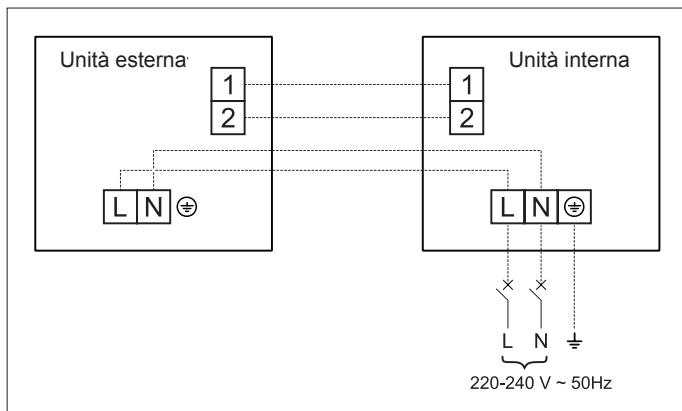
Collegamento di unità cassetta monofase con alimentazione interna.
